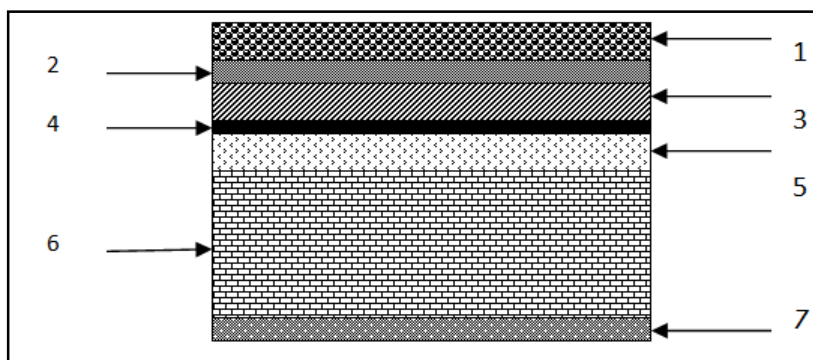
Coupe transversale au niveau de plancher en corps creux étage terrasse.
